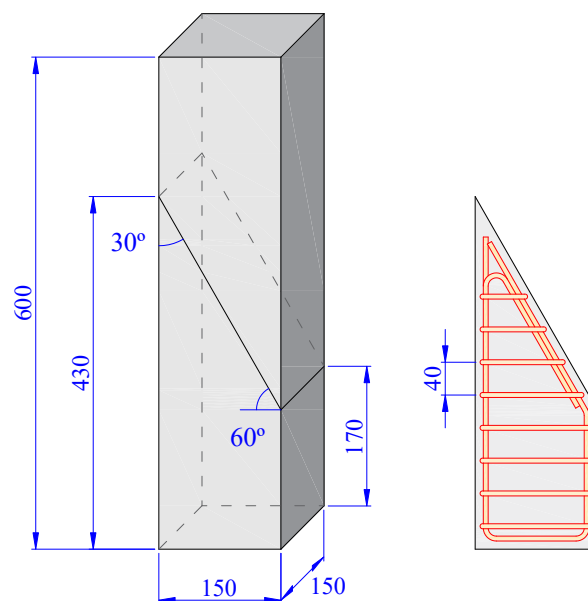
Geometria, dimensões e configuração das armaduras de cada metade dos provetes utilizados nos ensaios de corte inclinado (em mm).
